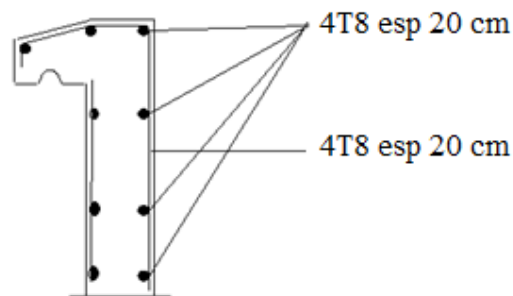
Schéma de ferrailage de l'acrotère .
